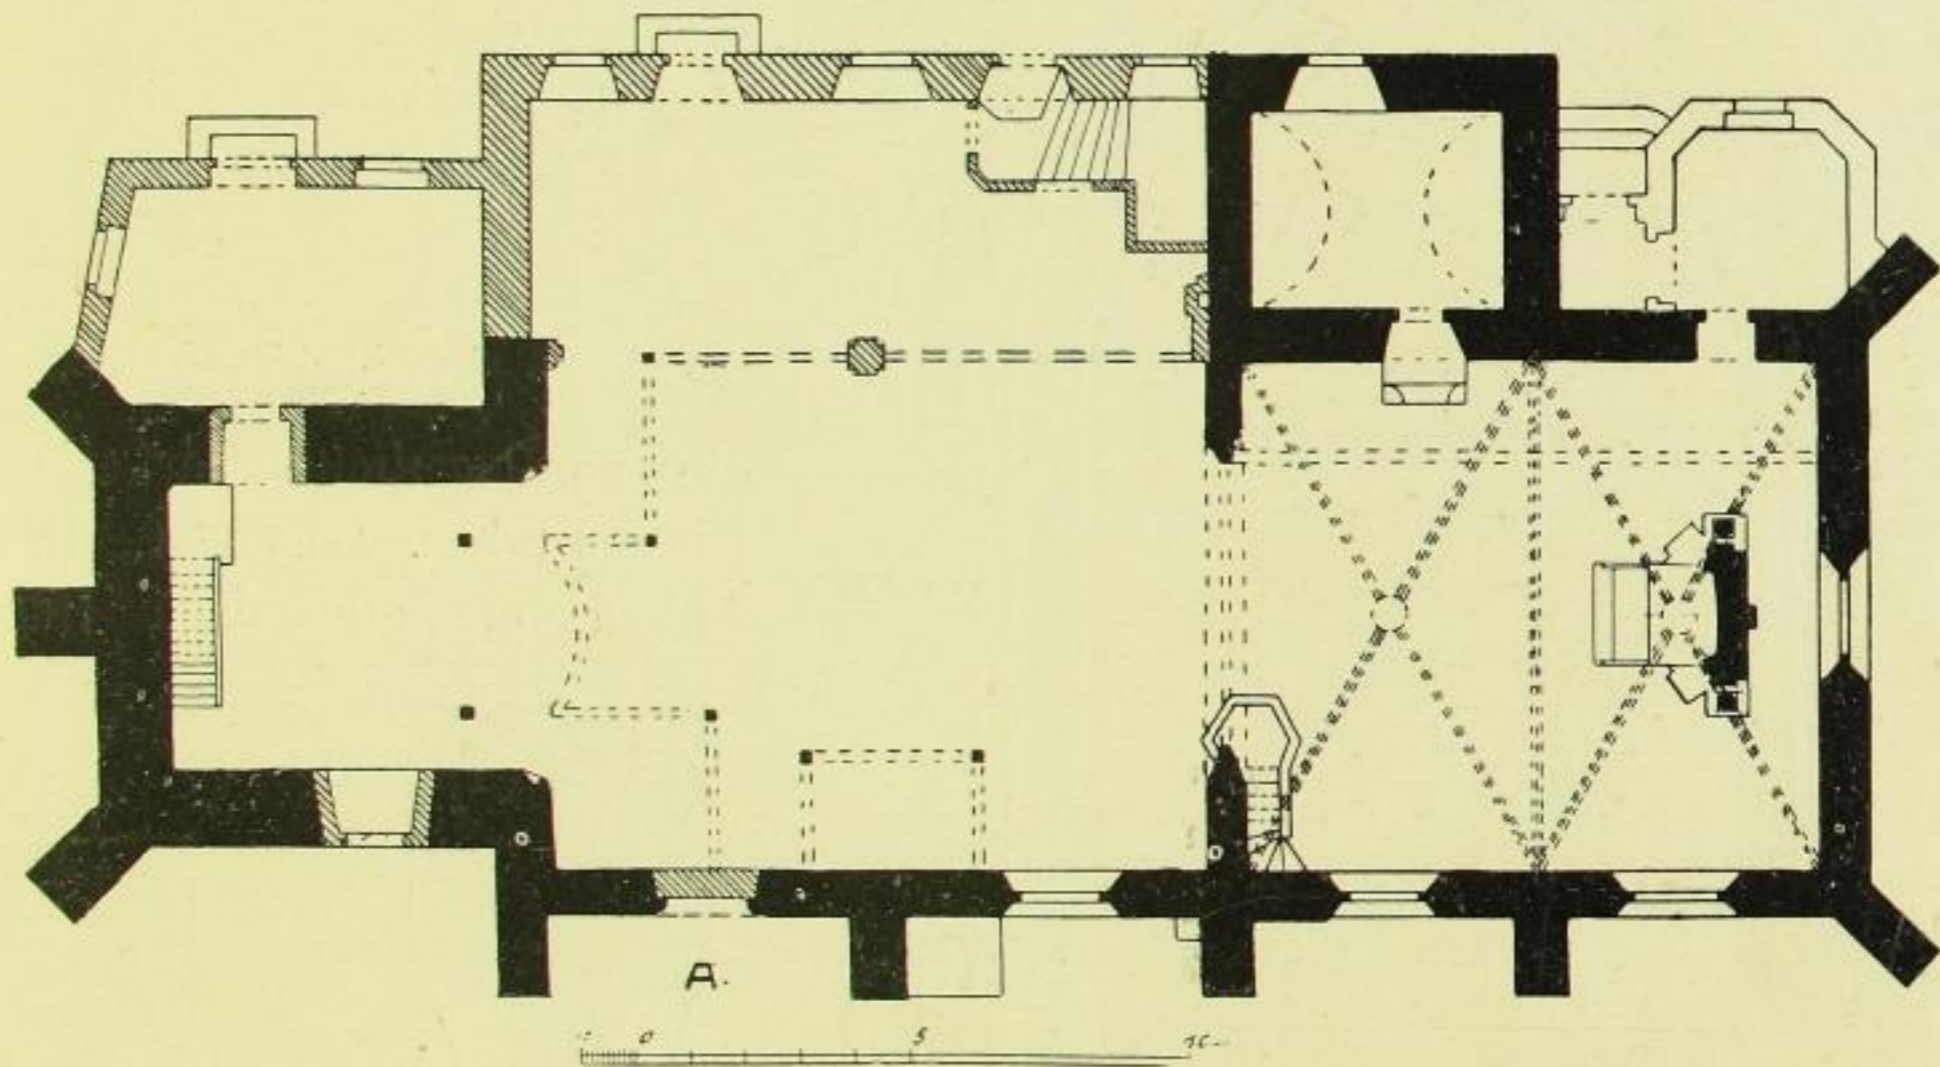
Leubnitz. Grundriss der Kirche.
